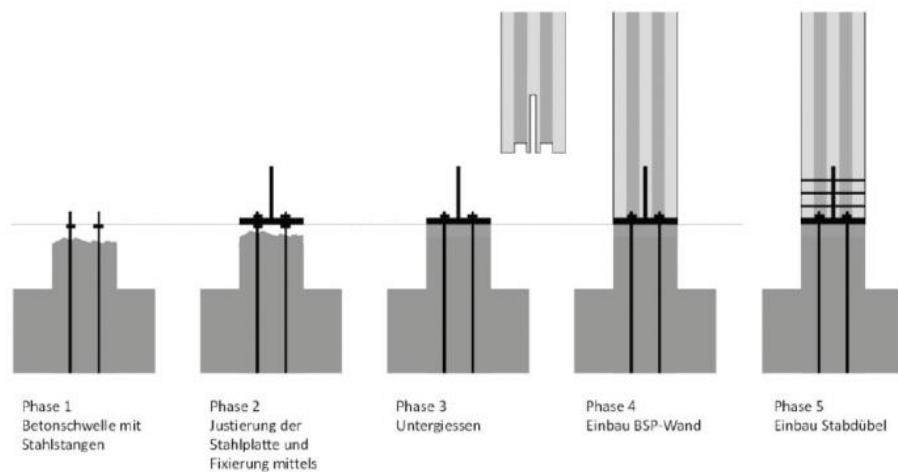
Montage der Verbindung der ersten BSP-Wand auf dem Betonfundament [78]
